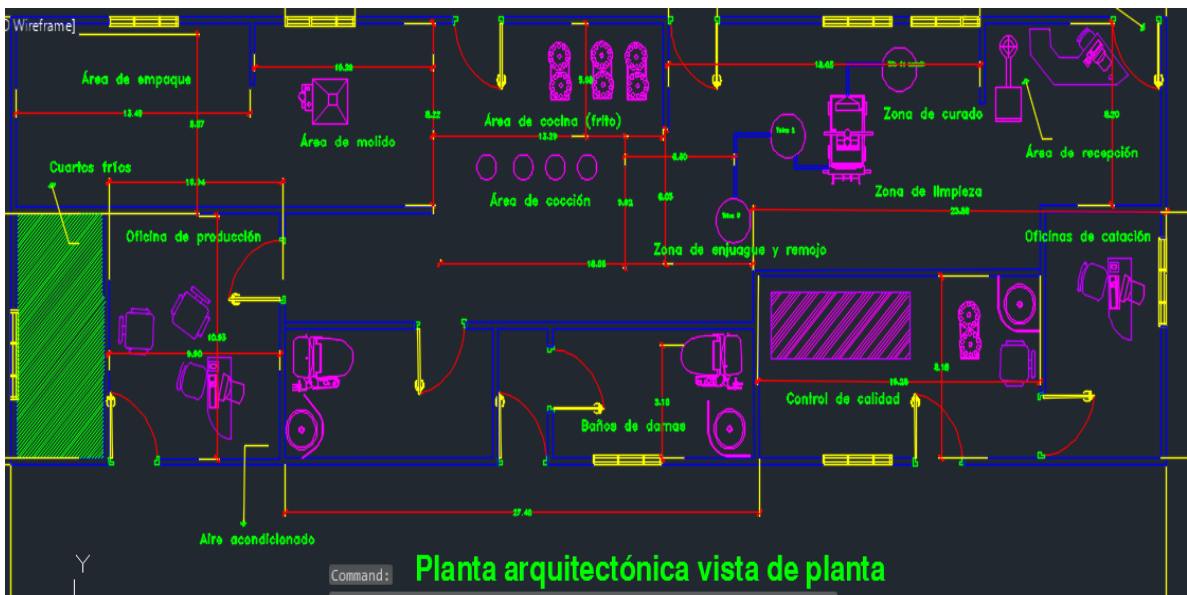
Vista de planta de la empresa, diseño Auto CAD
